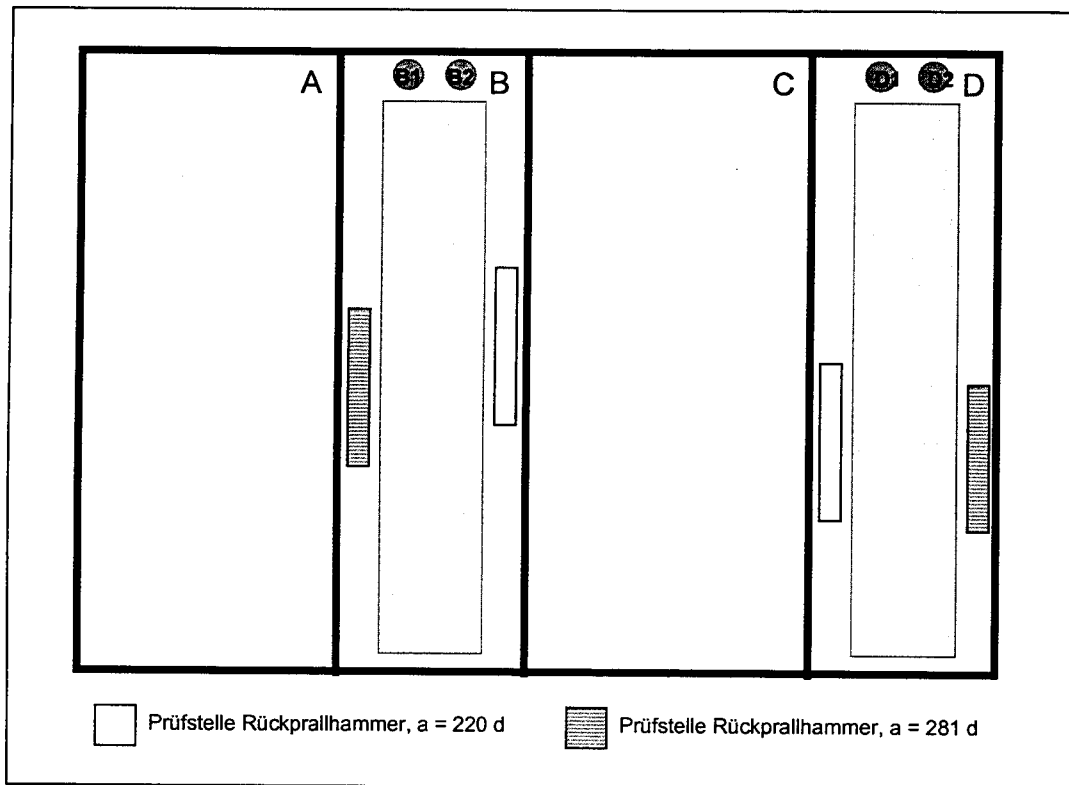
Lage der Prüfflächen am Betonkörper 25
